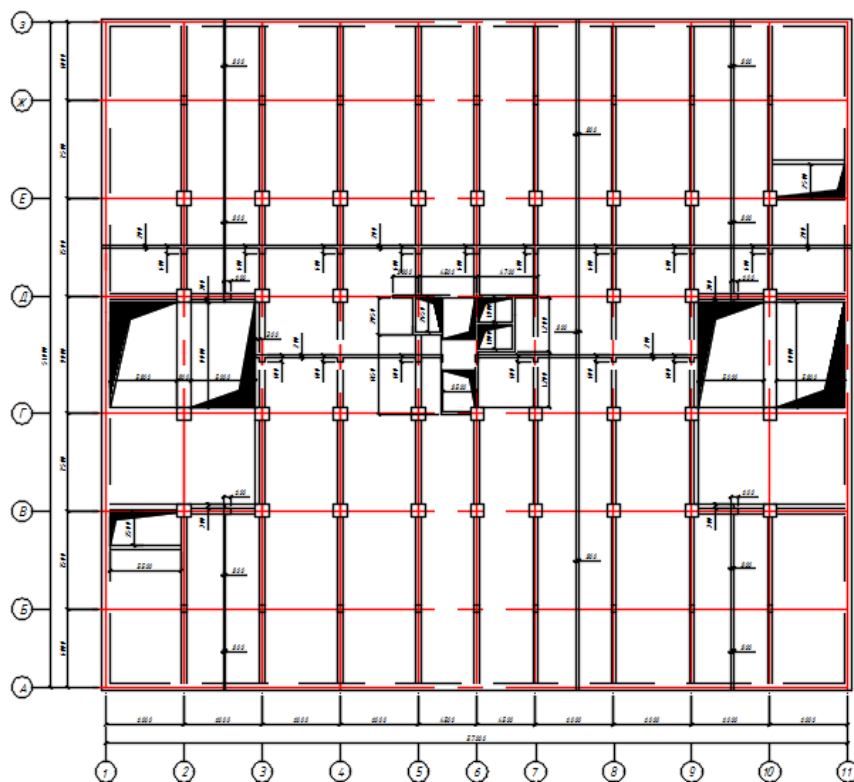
Монолитное перекрытие на отметке -10,620 м
